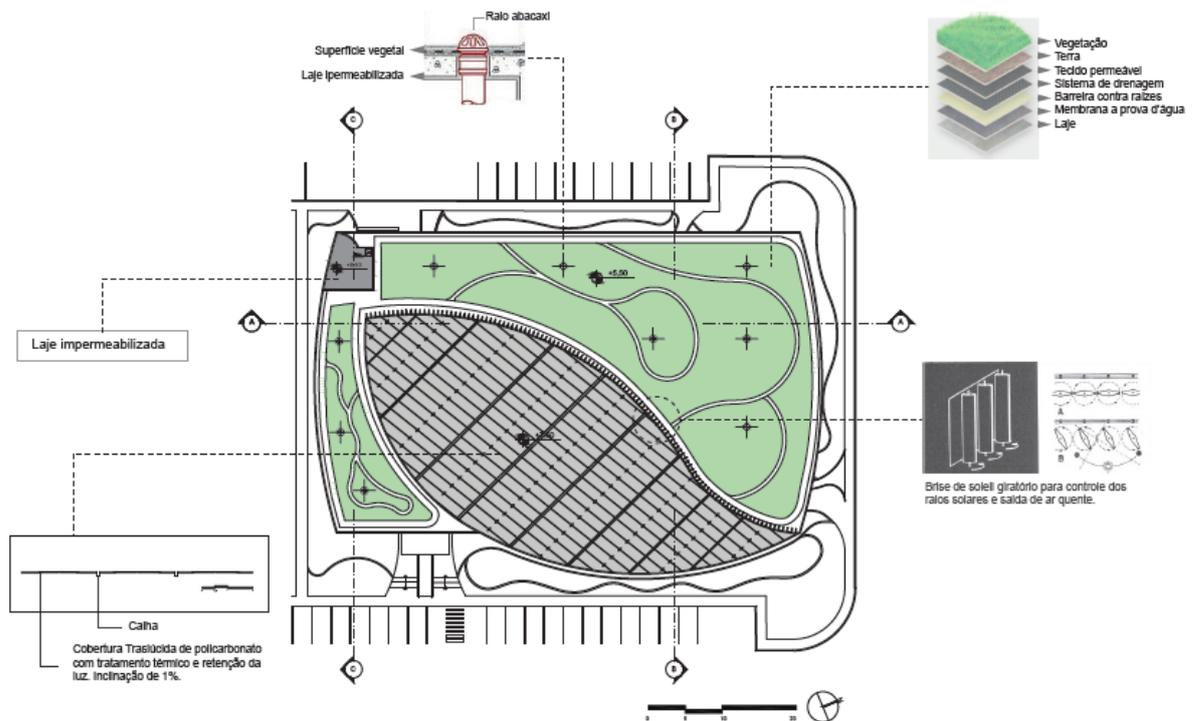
Planta de cobertura e detalhes. Fonte: Acervo do autor.
